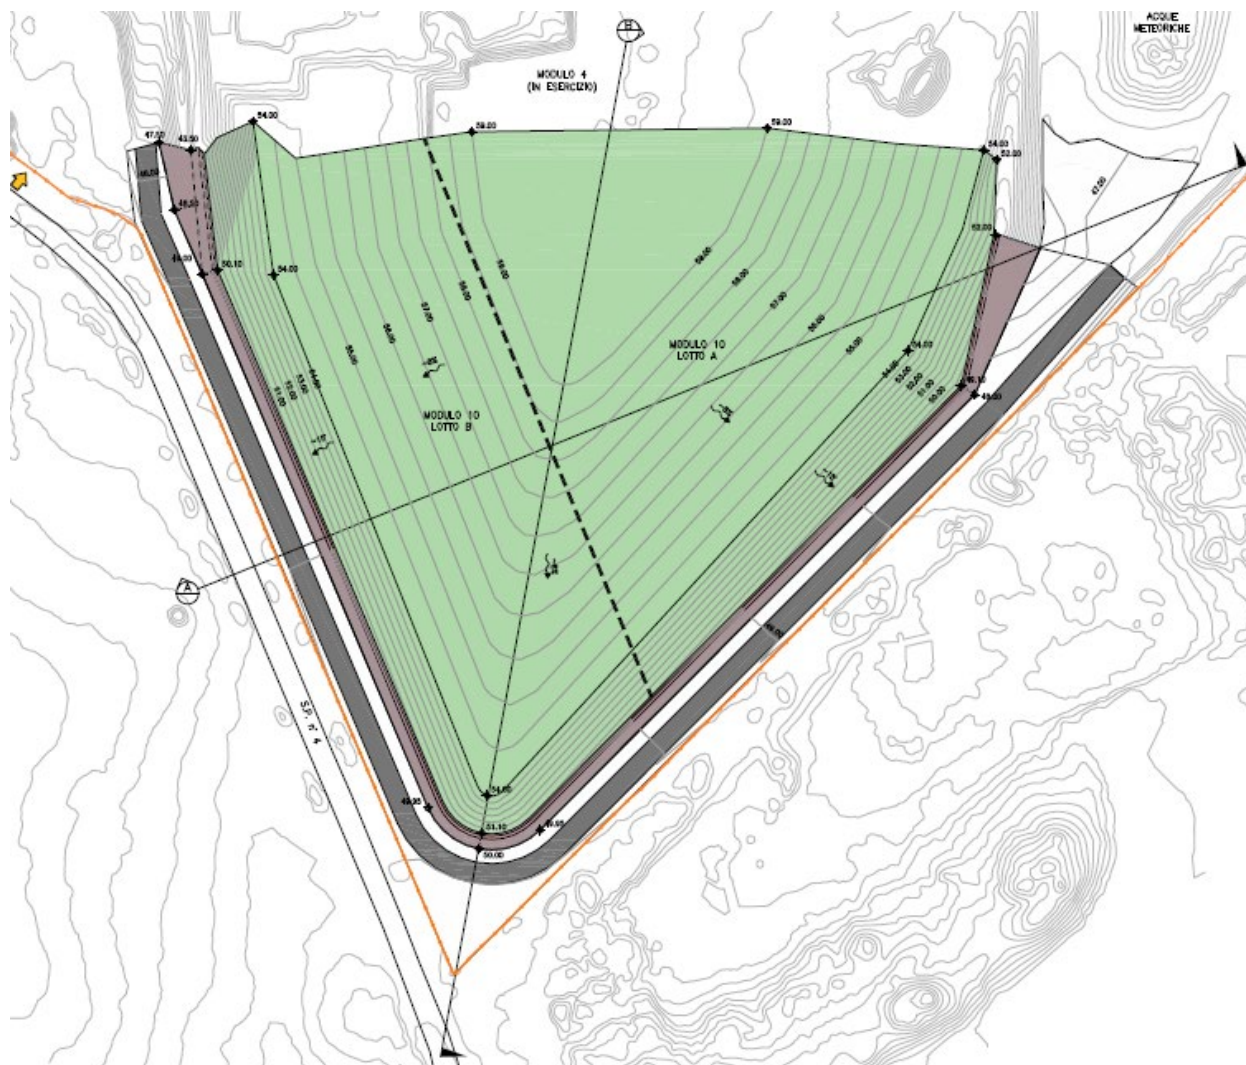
Stralcio planimetria fine conferimento rifiuti
